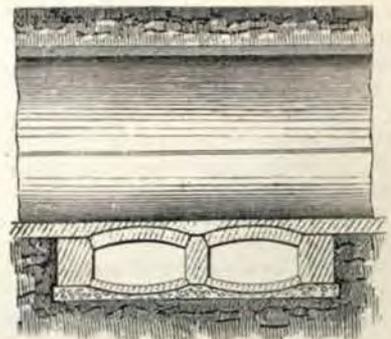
Passaggio dell'Holbeck sotto l'emissario. Sezione secondo l'asse del collettore.
